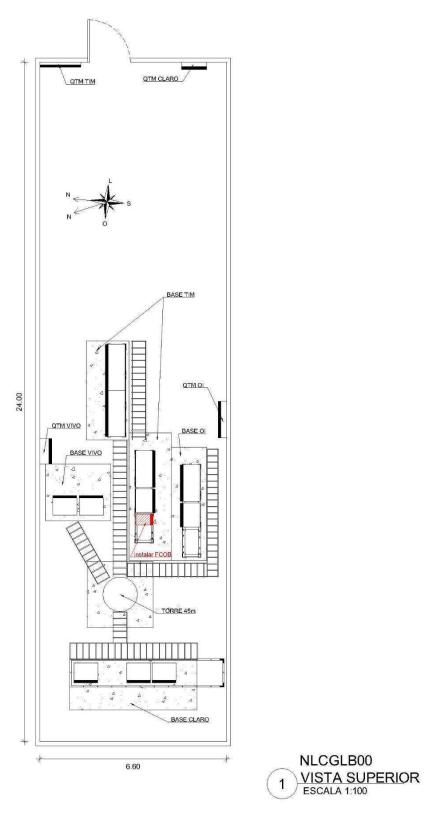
Planta baixa do site 3SLCGLB00 (Fonte: SAVENGE Engenharia LTDA)
